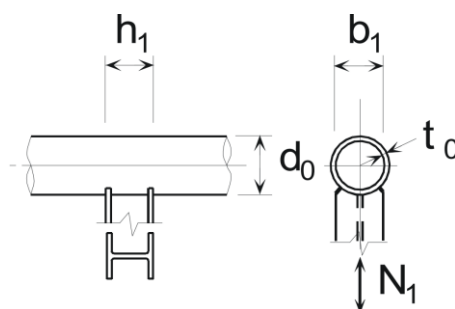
JUNTA SOLDADA EM T ENTRE DIAGONAL DE PERFIL I OU H E CORDA CHS (EC3-1-8 , QUADRO 7.4)
